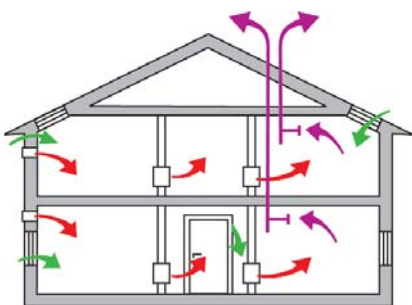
Ventilatorgestützte Lüftung, mit Installationsschacht
